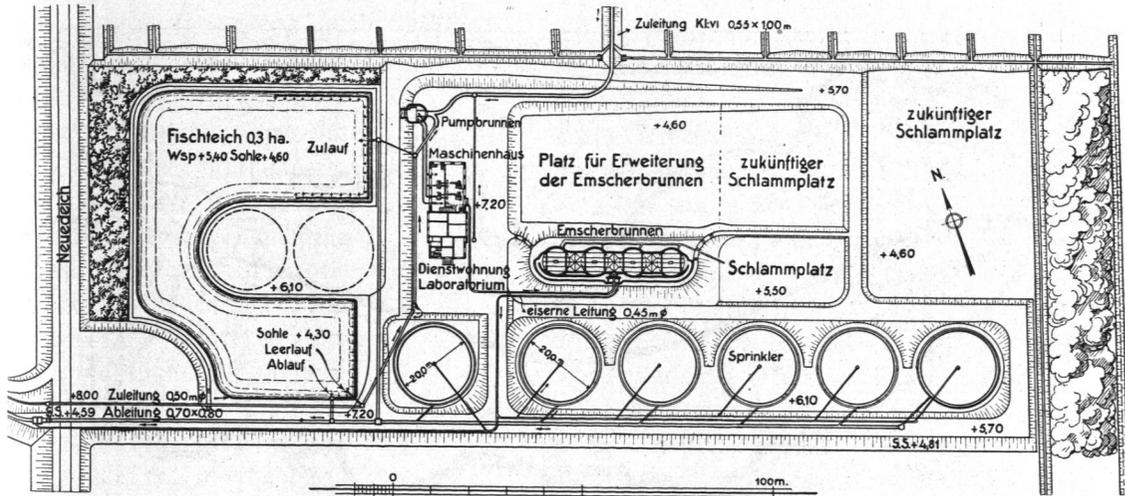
Biologische Kläranlage Bergedorf, Lageplan.
